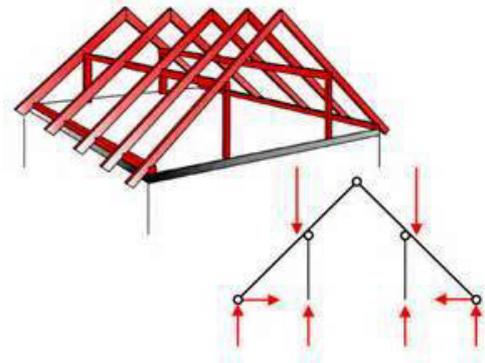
Zweifach stehender Pfettendachstuhl (Quelle: <http://www.dachbau-worms.de/dach-lexikon/p/pfettendach.html>)
